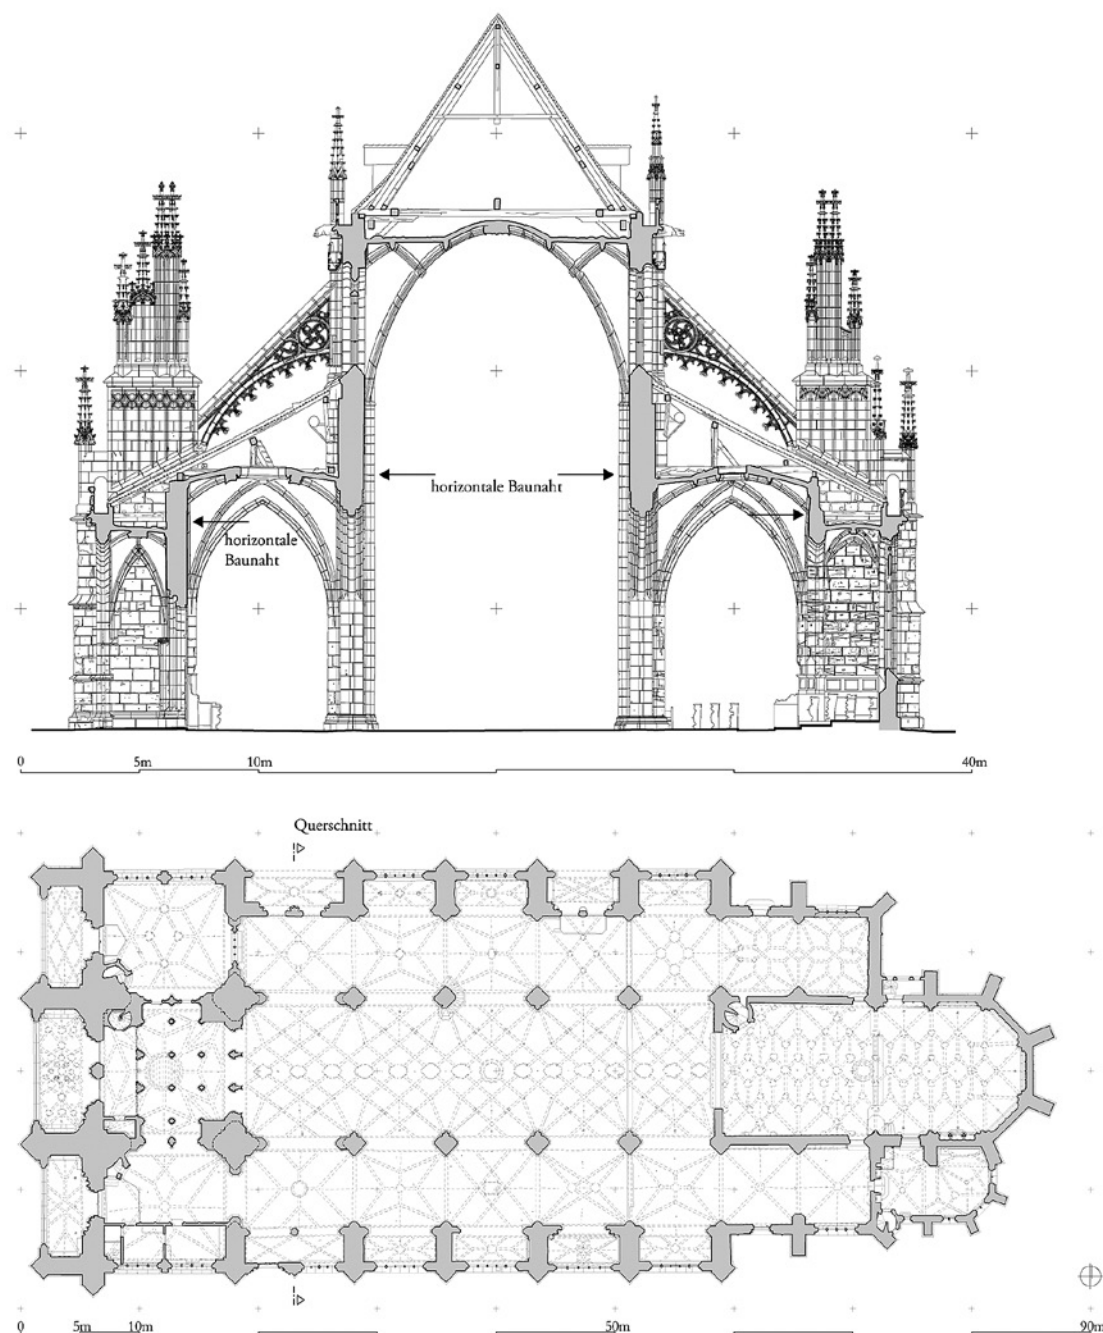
Berner Münster, Querschnitt und Grundriss
